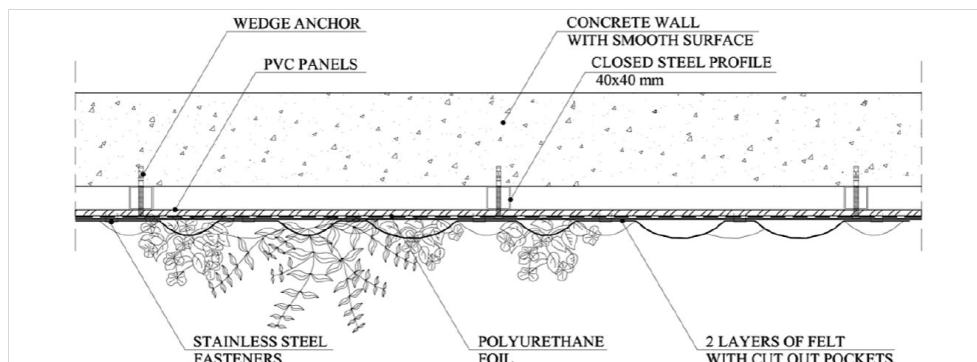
Patrick Blanc's green wall solution(출처 : Green Wall Technology, Maria Kmiec, 2014)
